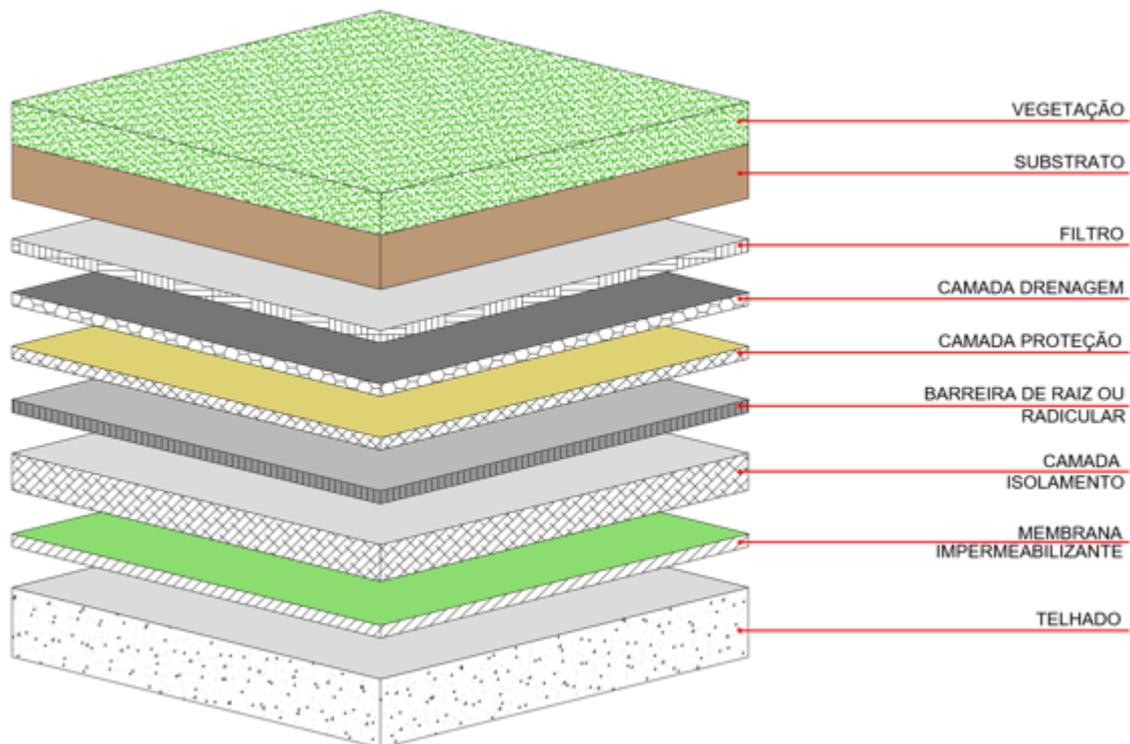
Componentes de um Telhado Verde. Adaptado de Vijayaraghavan.
